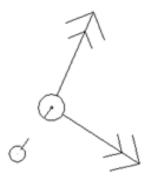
Железобетонный столб с оттяжкой по двум направлениям
